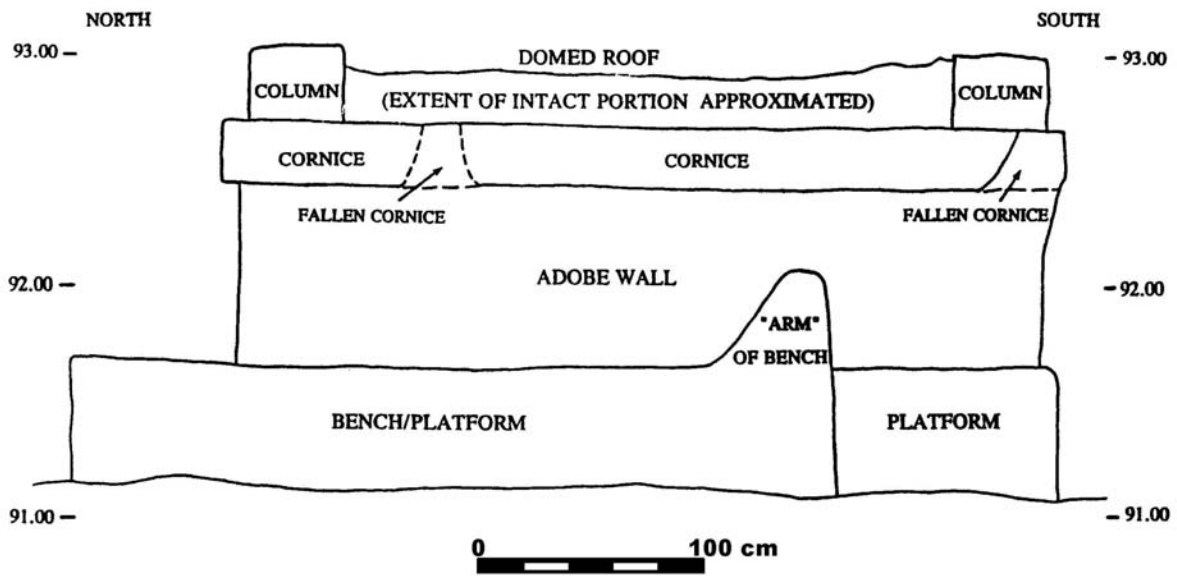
Perfil del lado oeste de la Estructura 9, Cerén
